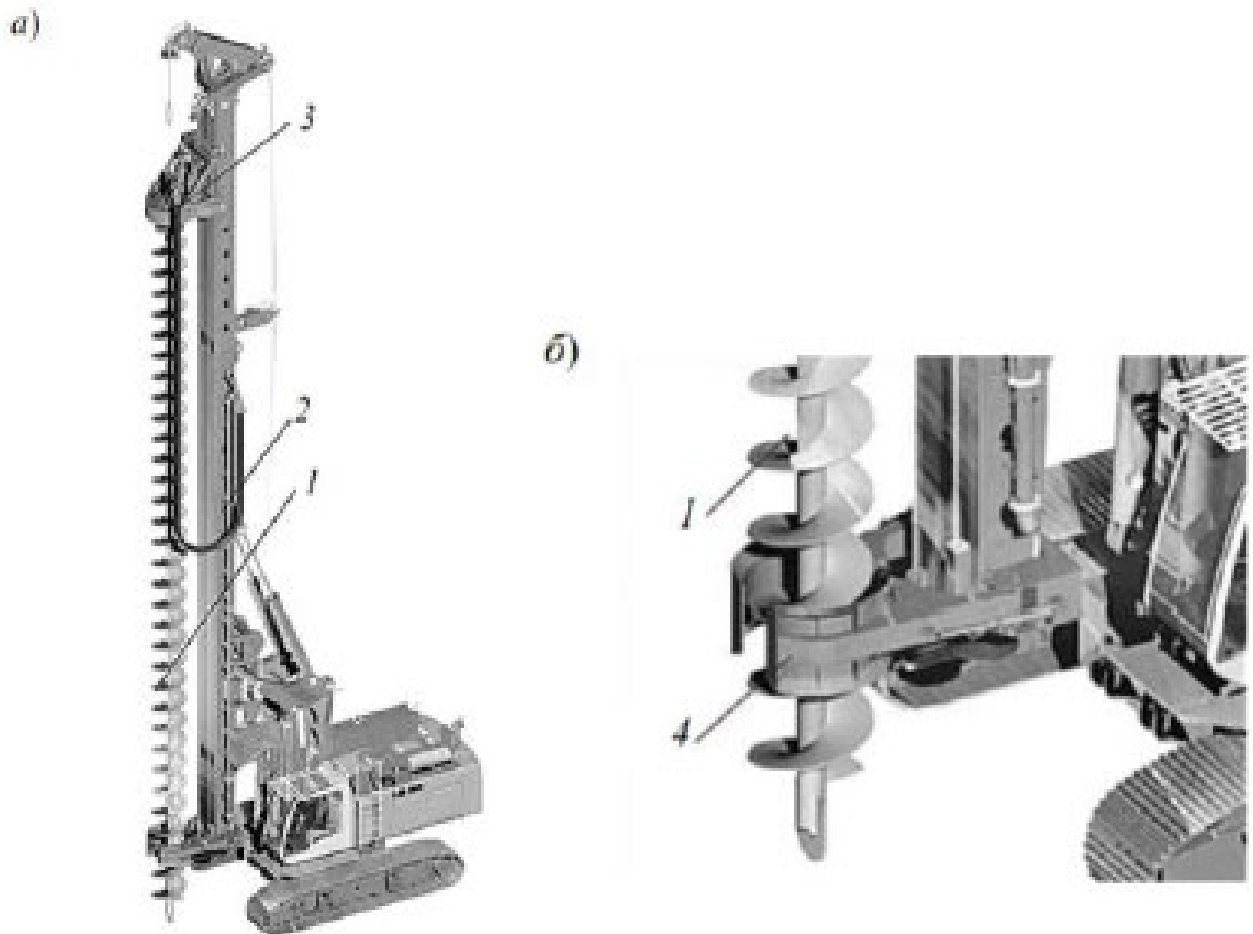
Установа, яка реалізує технологію прохідного шнека: а - загальний вигляд установки; б - вид нижньої частини шнека і очищувача; 1 - порожнистий прохідний шнек; 2 - напрямна стійка (бурова щогла); 3 - ротор (вращатель); 4 - очищувач шнека від ґрунту; 5 - базова машина
